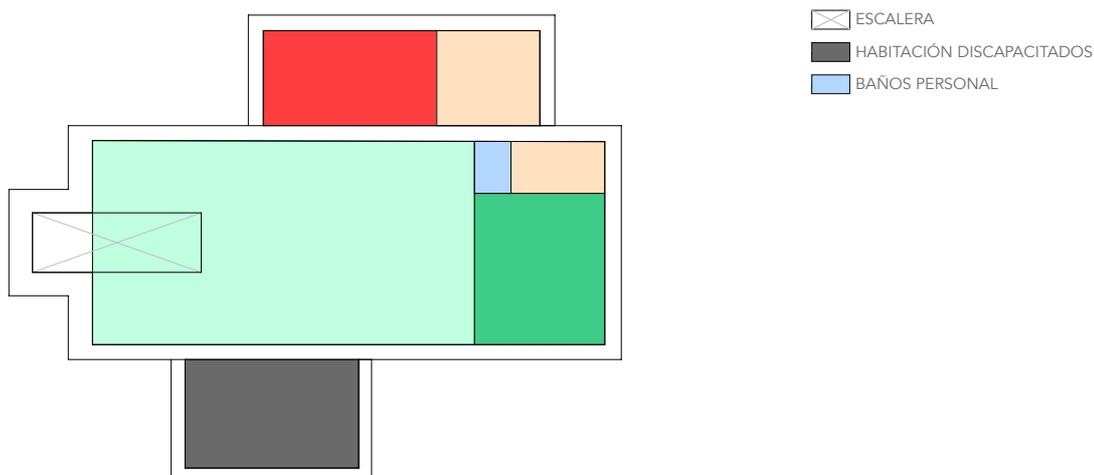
Planteamiento 4 de la distribución planta baja.
